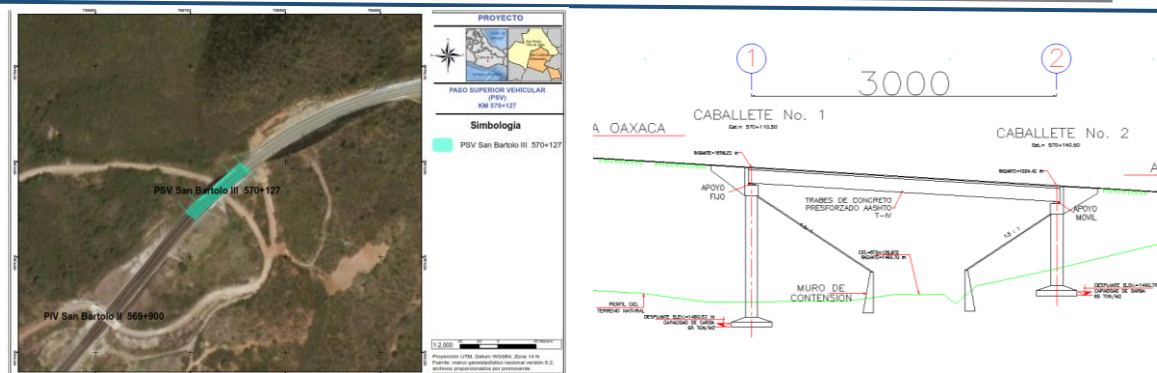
Proyecto en planta y corte longitudinal del PSV 570+127 San Bartolo III.
